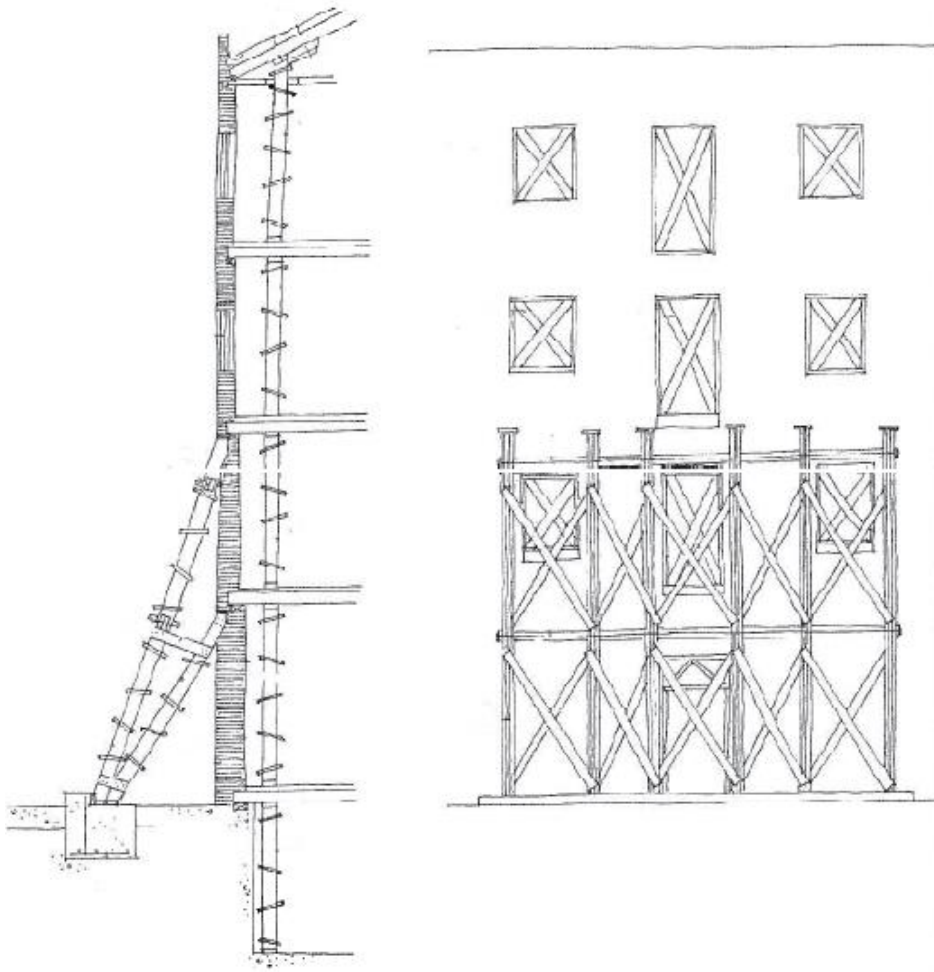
Solución de apeo de muro de más de dos plantas.
